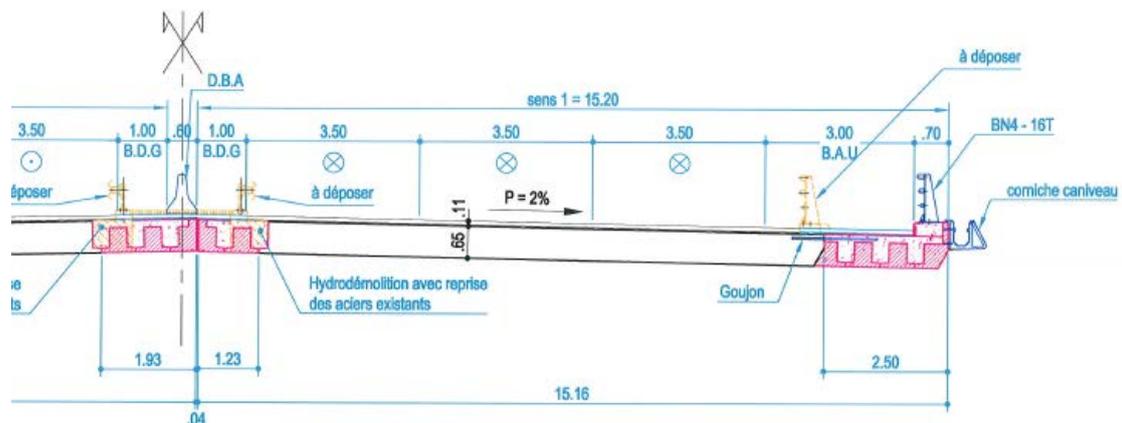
Elargissement structural du tablier d'un pont-dalle (coupe type)
